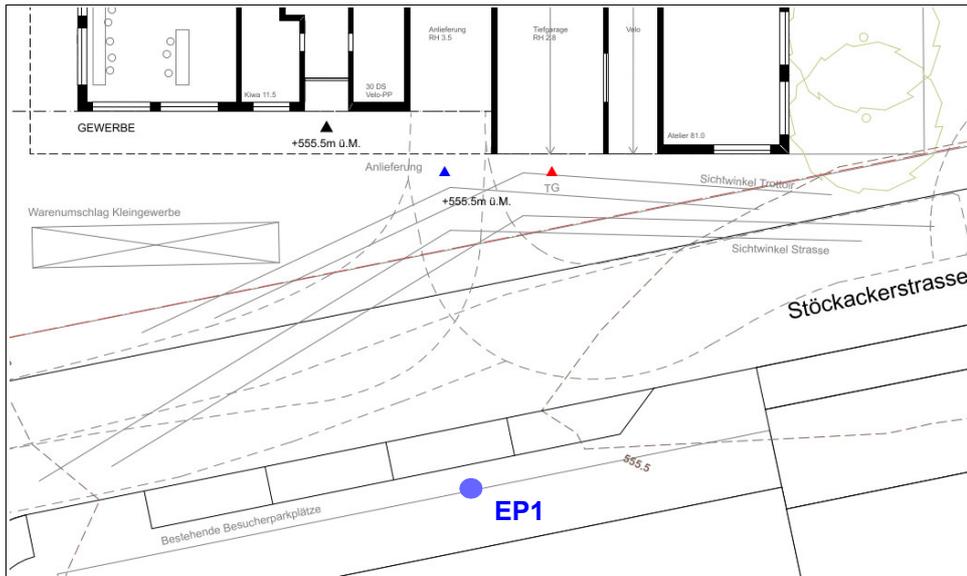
Grundriss EG – Empfangspunkt EP 1 Gebäude Stöckackerstr. 89
